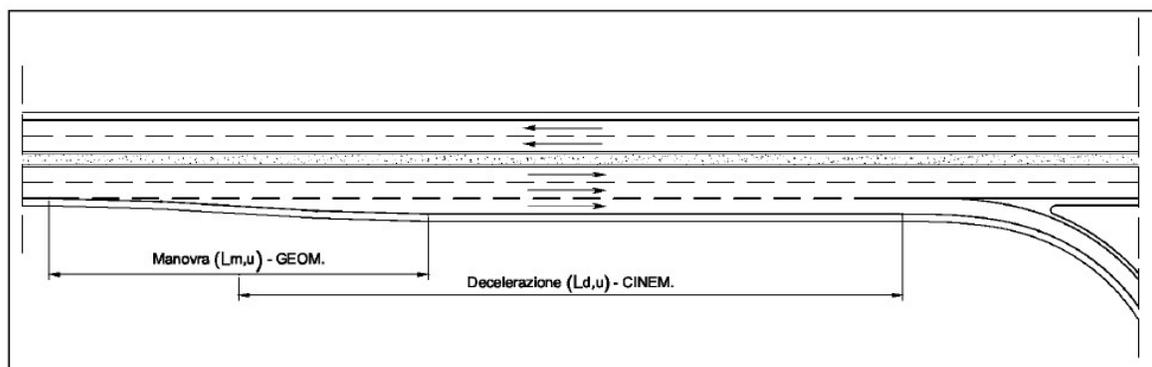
Schema planimetrico corsia di diversione – tipologia parallela.
